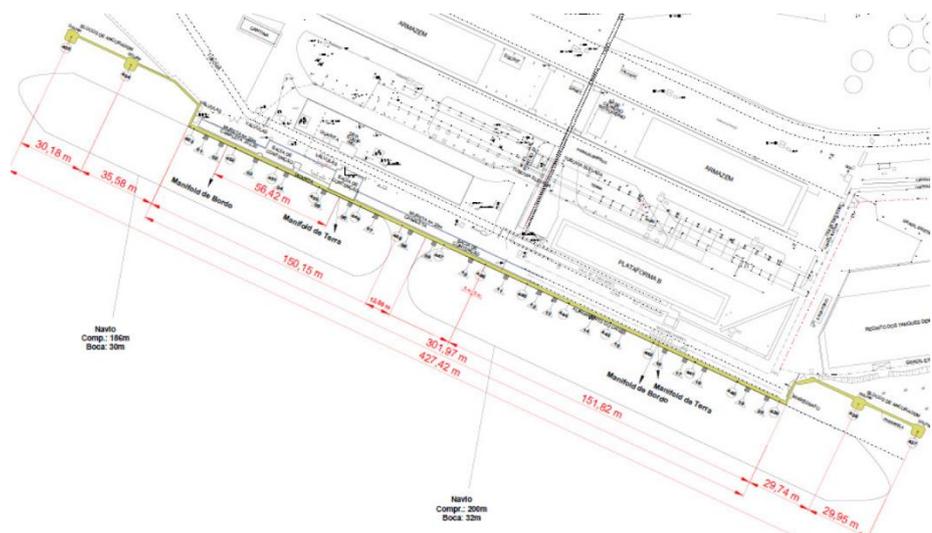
Planta de Localização dos Cais Bocaina e São Paulo
